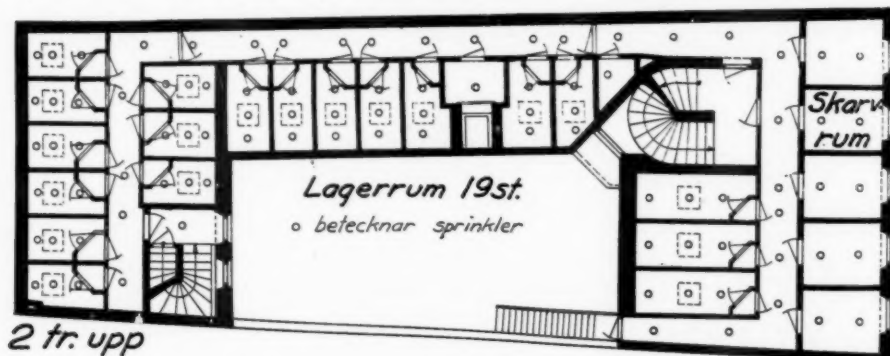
Grundriss der Lagerabteilung mit den 19 Kasematten. o bedeutet Kopf der Sprühregen-vorrichtung (nach SCHLYTER).
